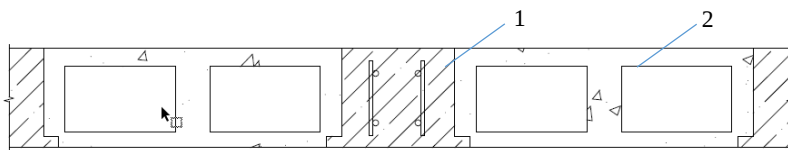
Традиционное исполнение сборно-монолитного перекрытия: 1 – несущая монолитная железобетонная балка, 2 – вкладыш из тяжелого бетона
